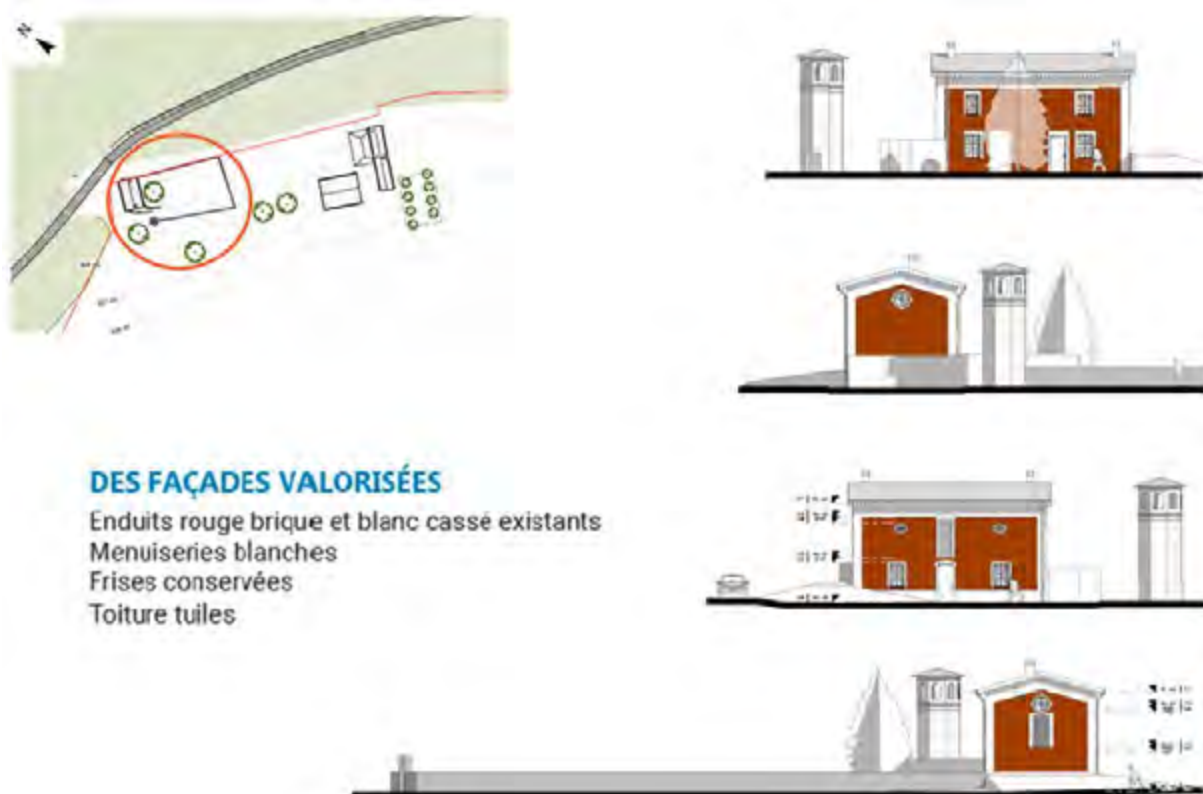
Plans de la maison du régisseur située à l'entrée du site (source : Espace Gaïa)
